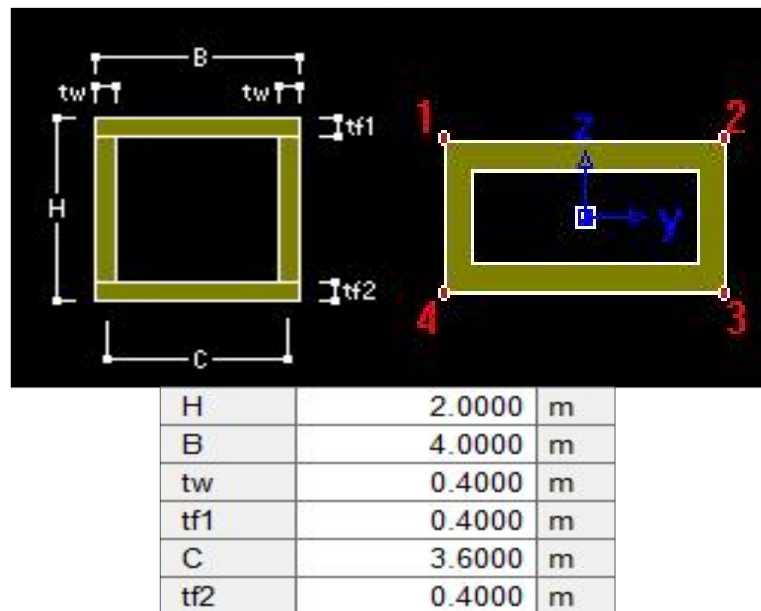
Sección transversal rectangular hueca de las pilas extremas.
